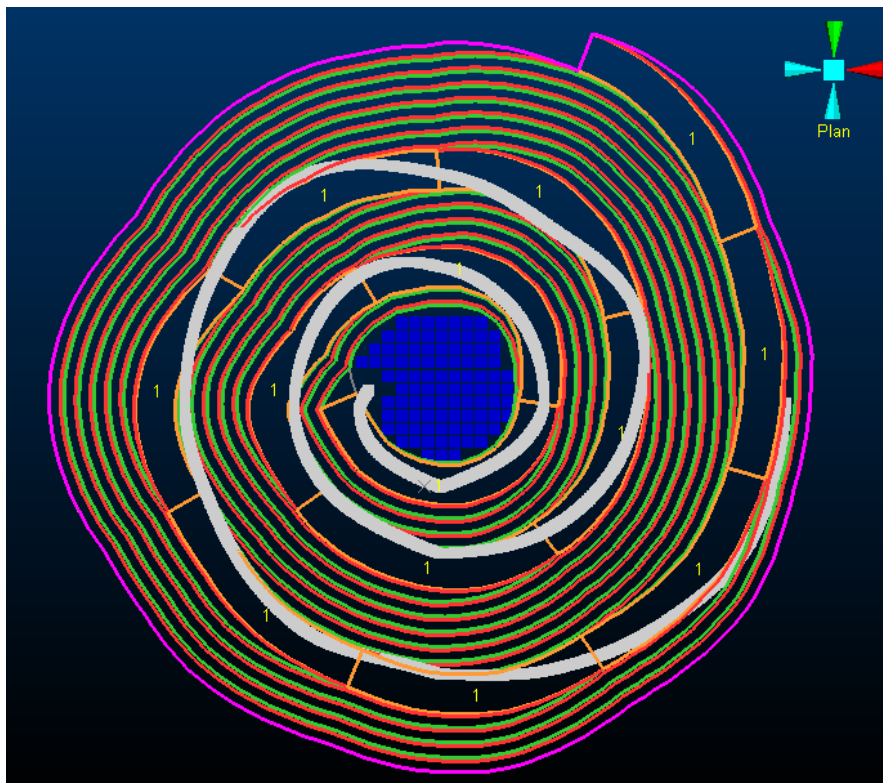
Vista planta ajuste pit suavizado y línea de puntos.
